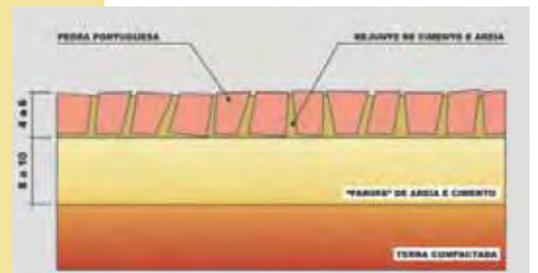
Modelo esquemático para aplicação de piso intertravado
